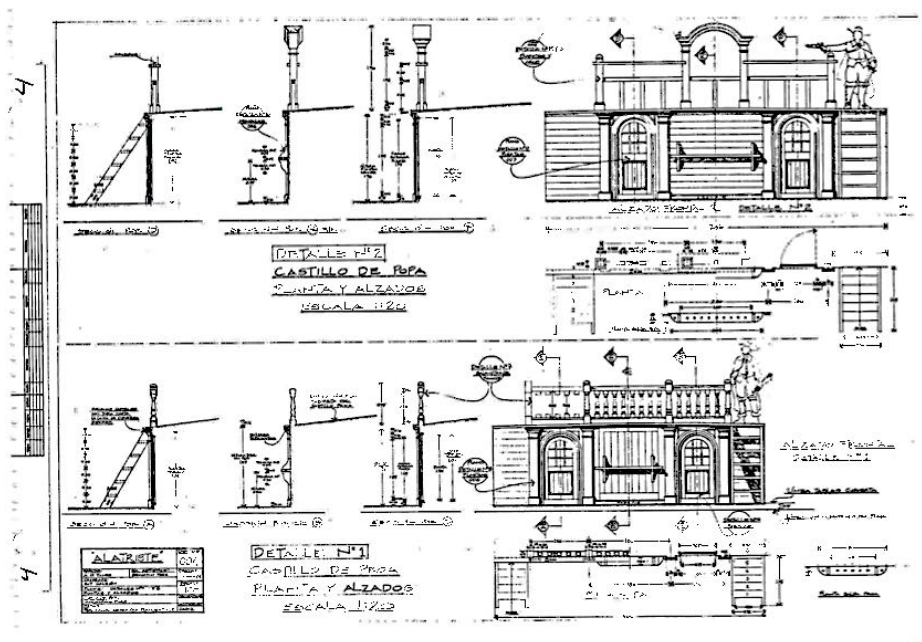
Plano. Galeón. Planta y alzados. Castillo de proa. *Alatraste*.
